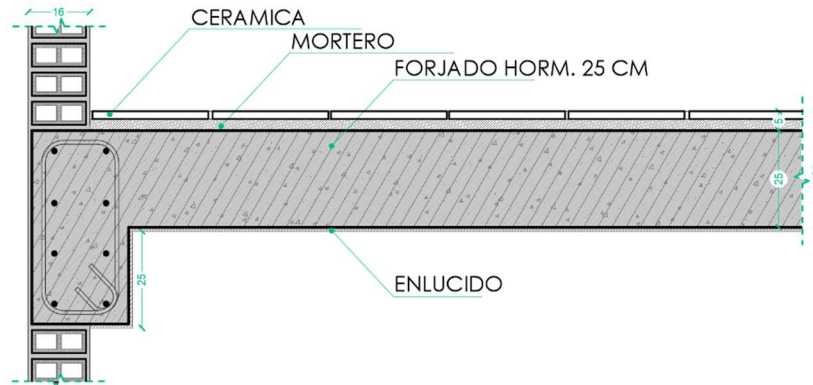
Detalle constructivo de forjado. Elaboración propia
